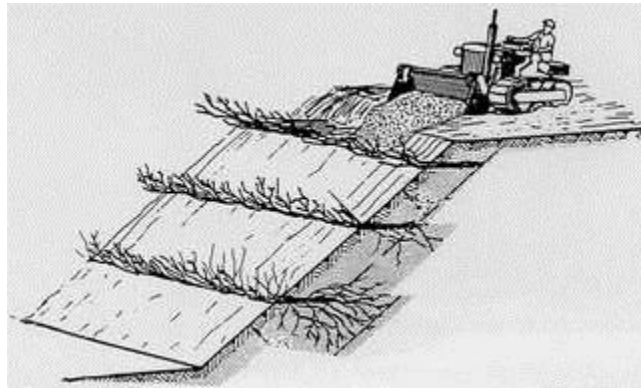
Construcción de lechos de ramaje en taludes de terraplenes.
